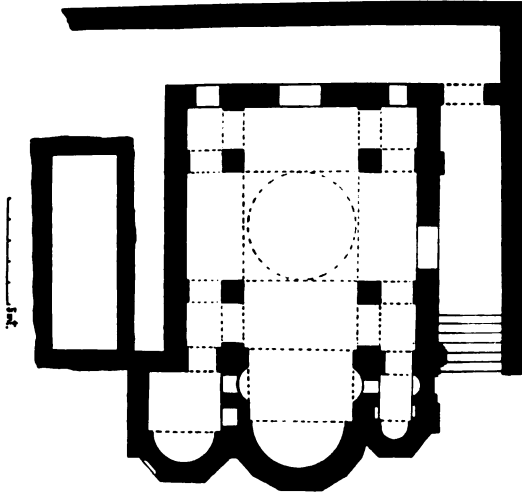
Rekonstruktion des Grundrisses der Odalar-Djami.
